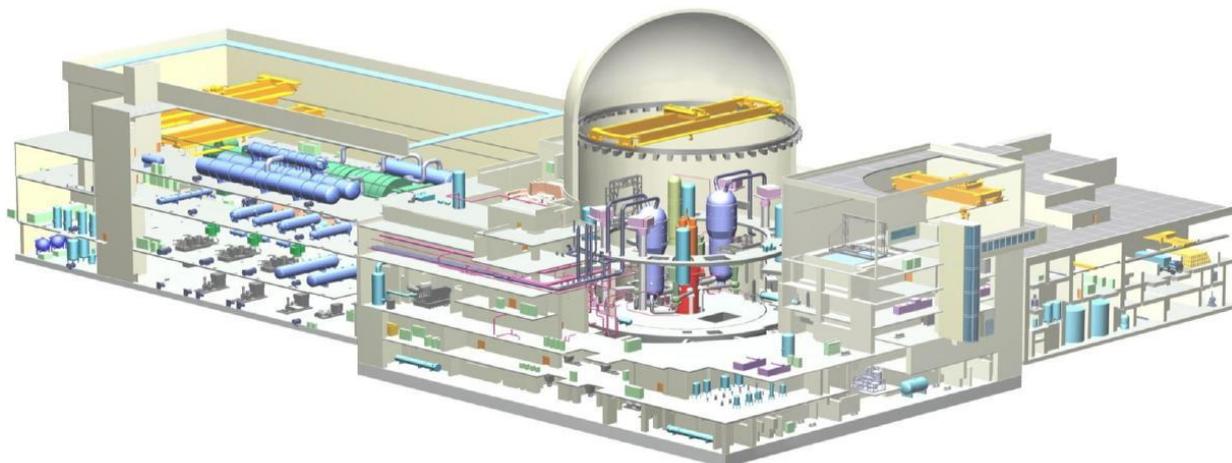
Наглядный вид блока APR1400 [18]
